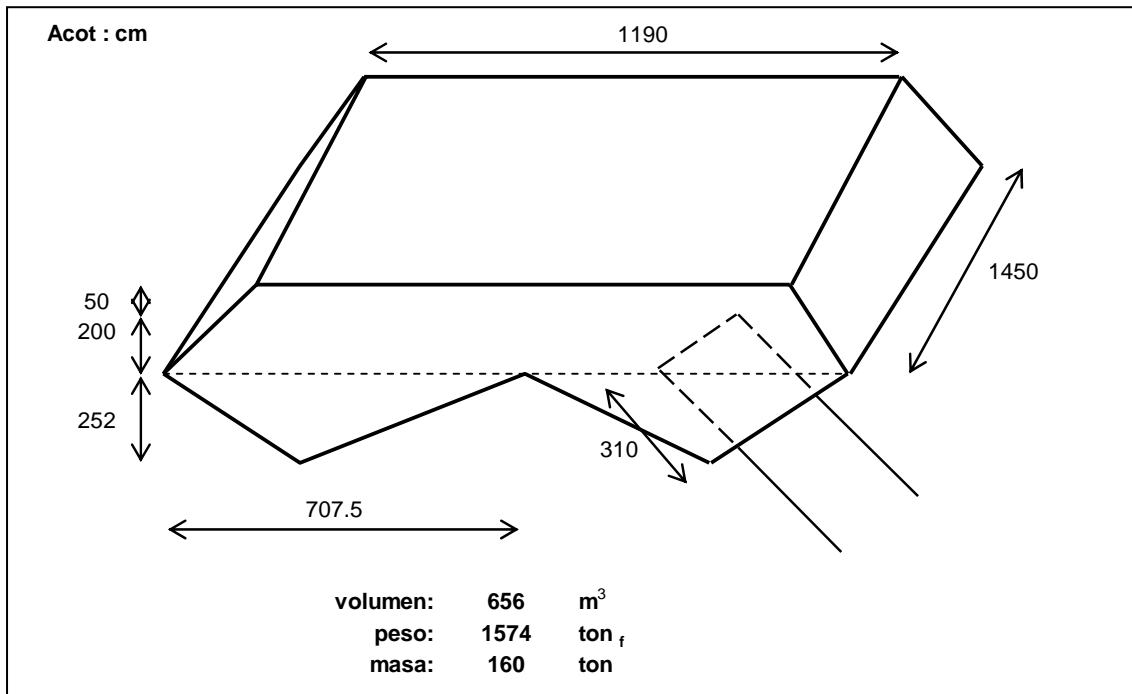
Cabezal 2, para las pilas 3 a 7
